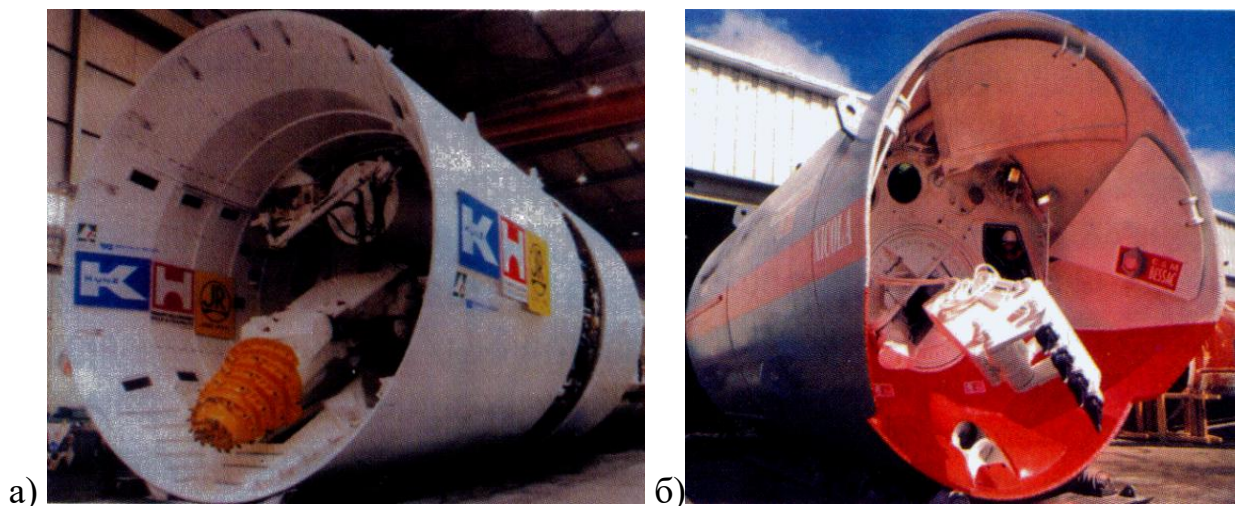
Тоннелепроходческие комплексы с исполнительными органами избирательного действия: а – с резцовой коронкой фрезерного типа; б – с ковшом
